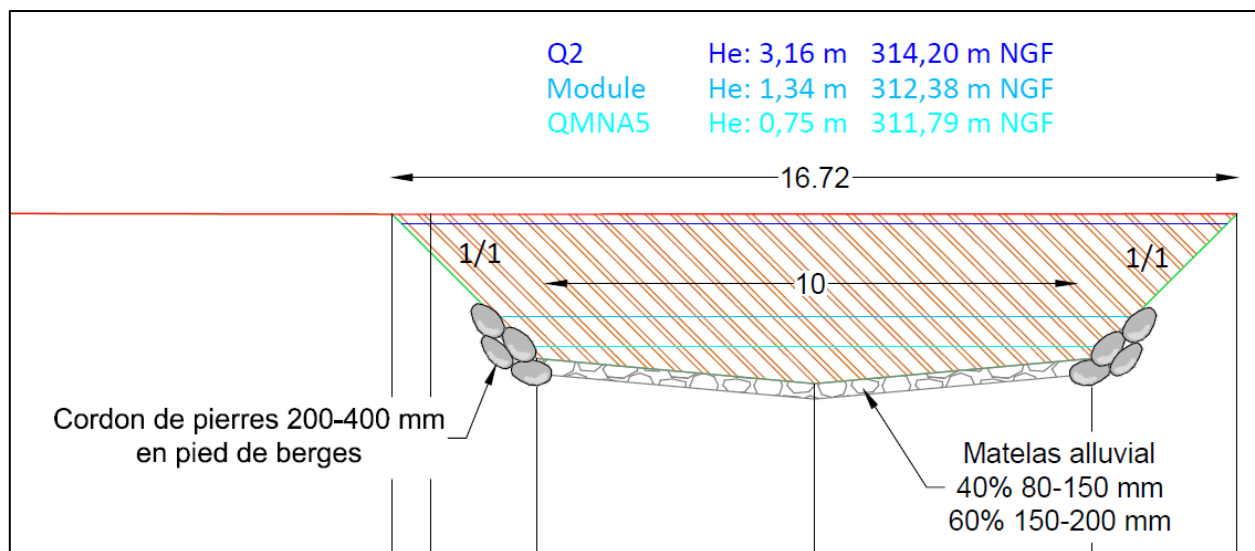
Profil en travers de la prise d'eau du bras de contournement (PT149) (scénario RCE2)
